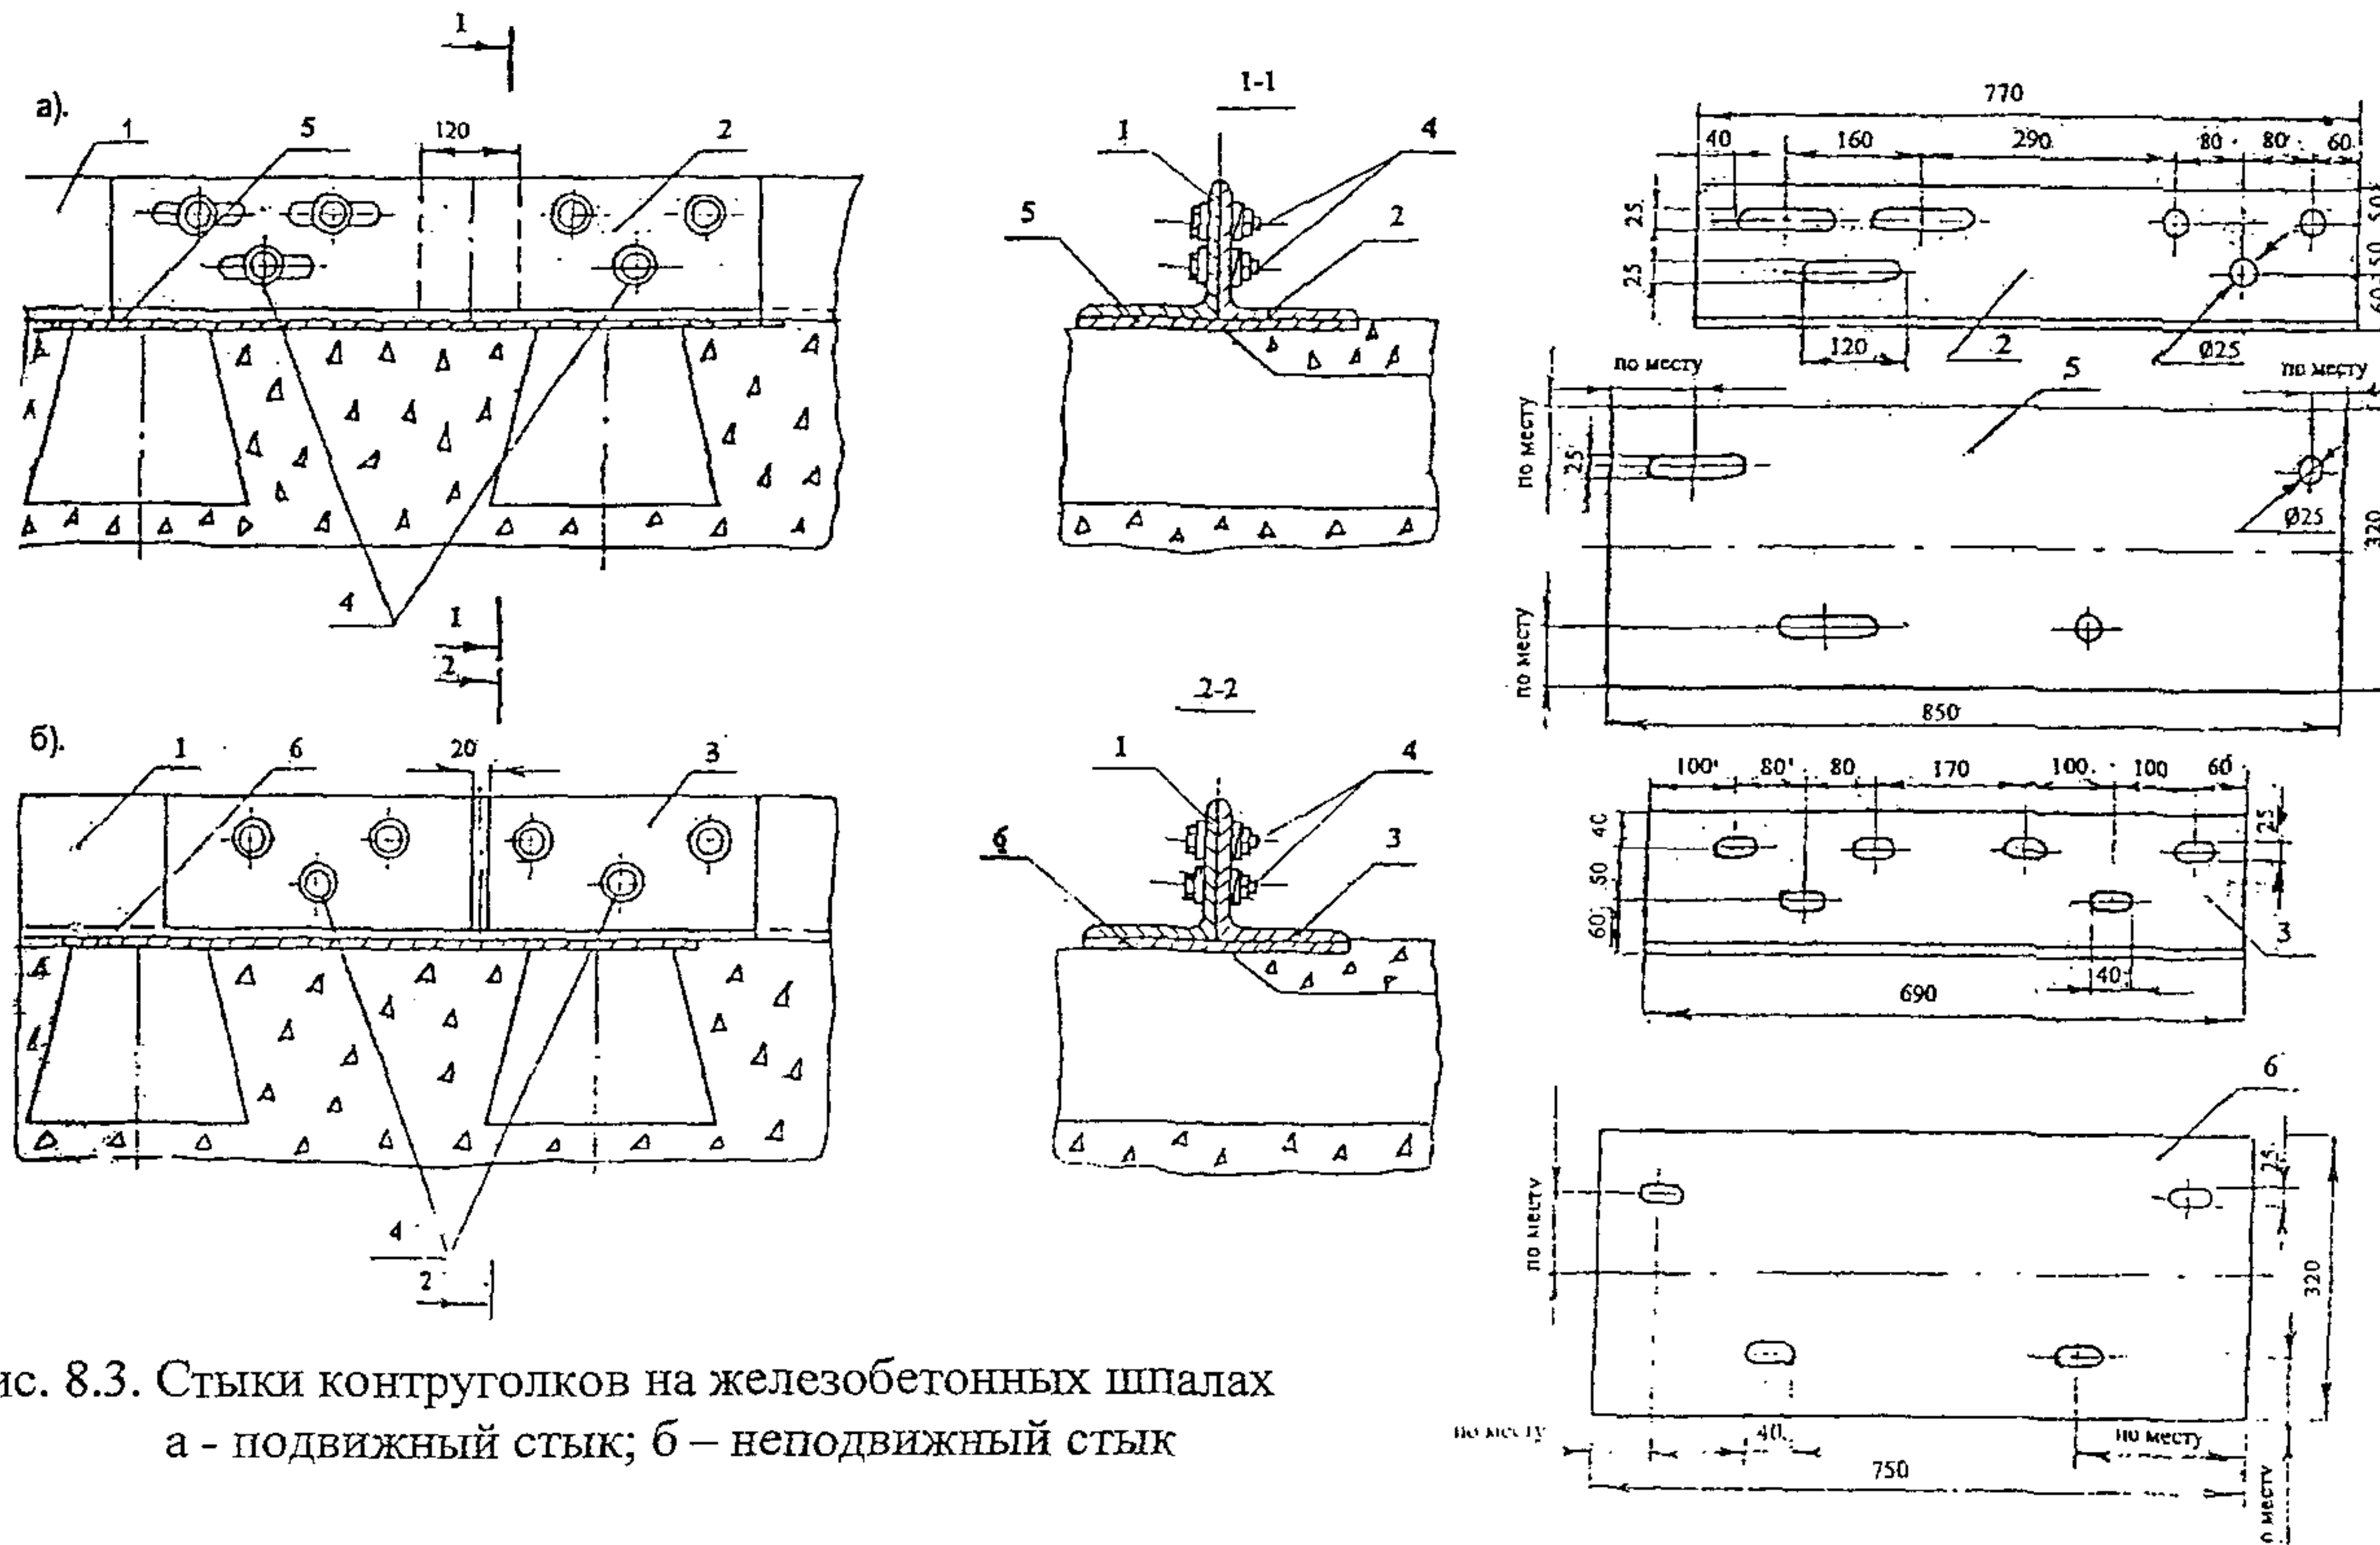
Стыки контруголок на железобетонных шпалах
